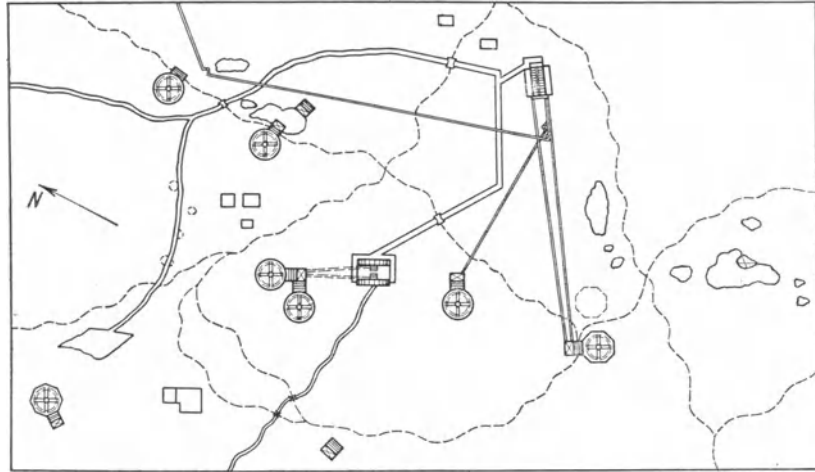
Plan der Silbergrube zu Sala aus dem Jahre 1696.
